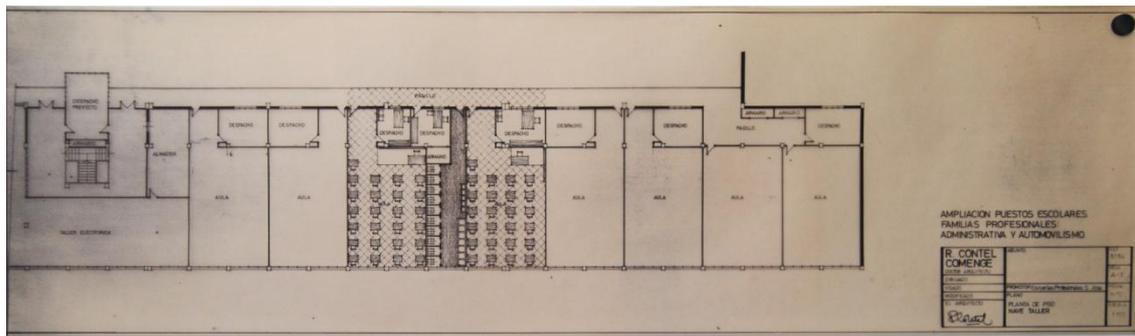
Plano ampliación planta primera. *Archivo Escuelas San José.
